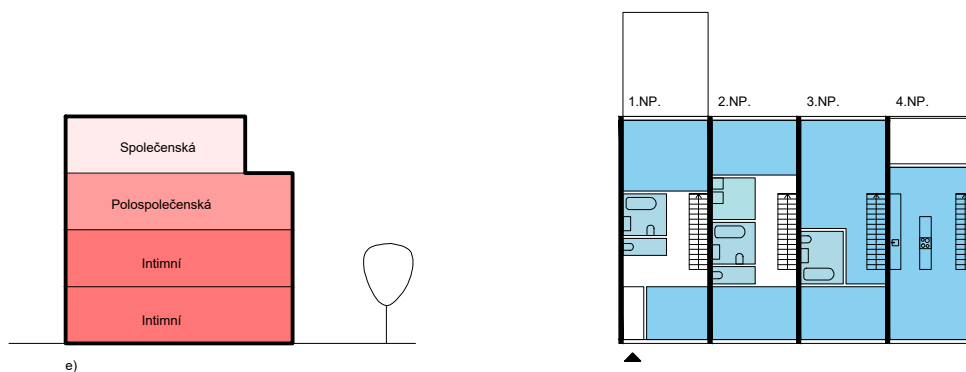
Zónování townhousu – varianta c (Zdroj: autor Erik Petrus)
